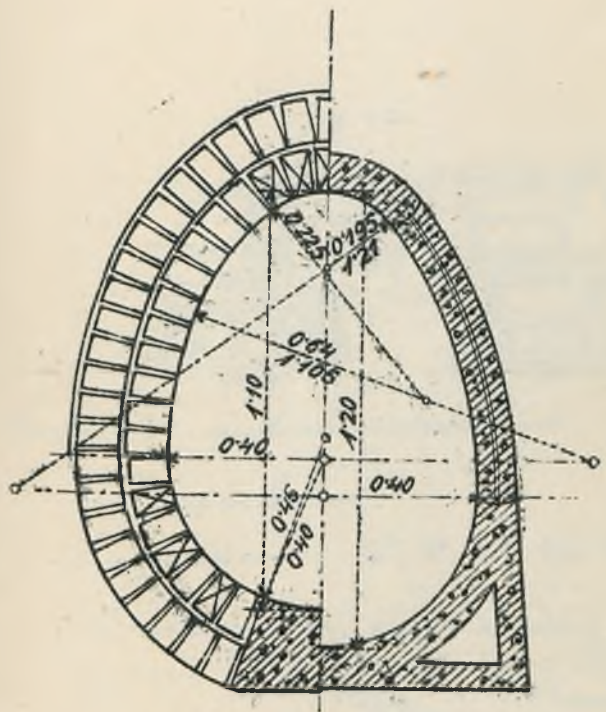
Odwrócony profil jagny z ramy kształtek betonowych.
